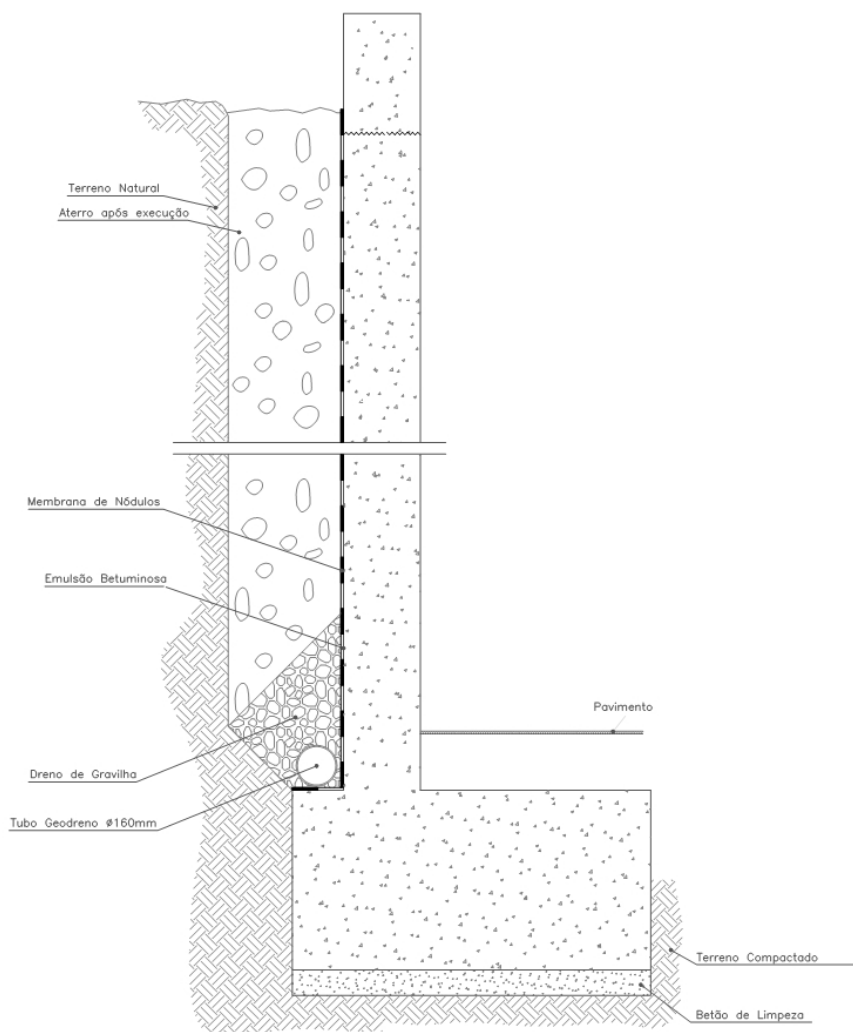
Sistema de impermeabilização e drenagem dos muros de suporte
